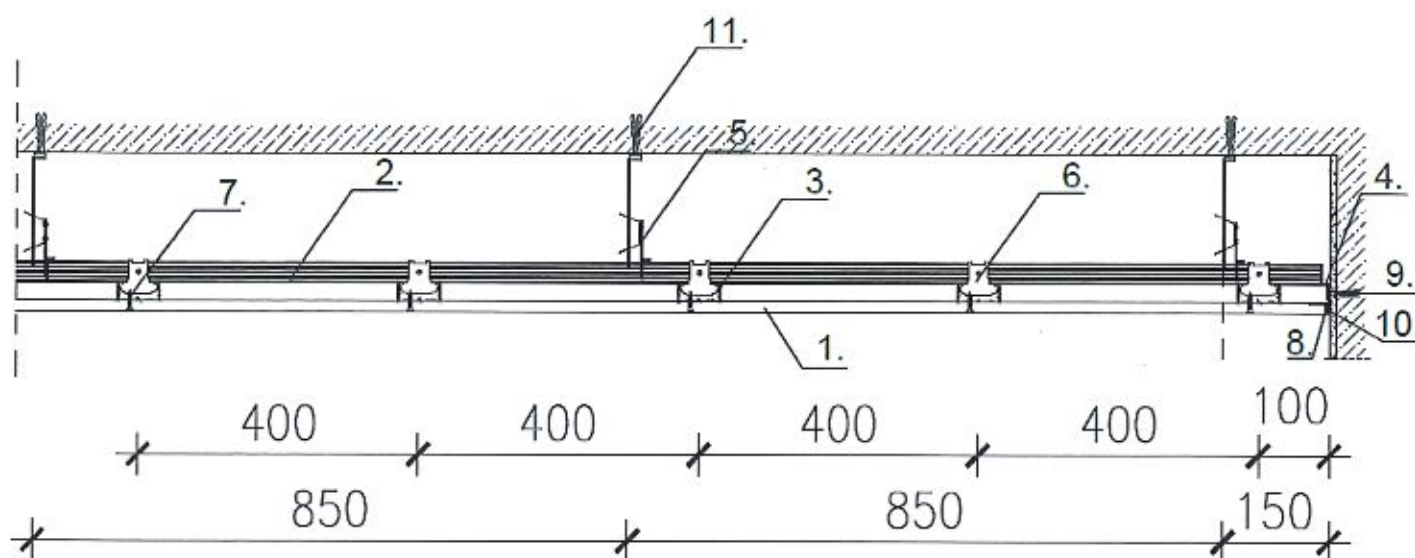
Widok sufitu podwieszanego – konstrukcja krzyżowa dwupoziomowa
